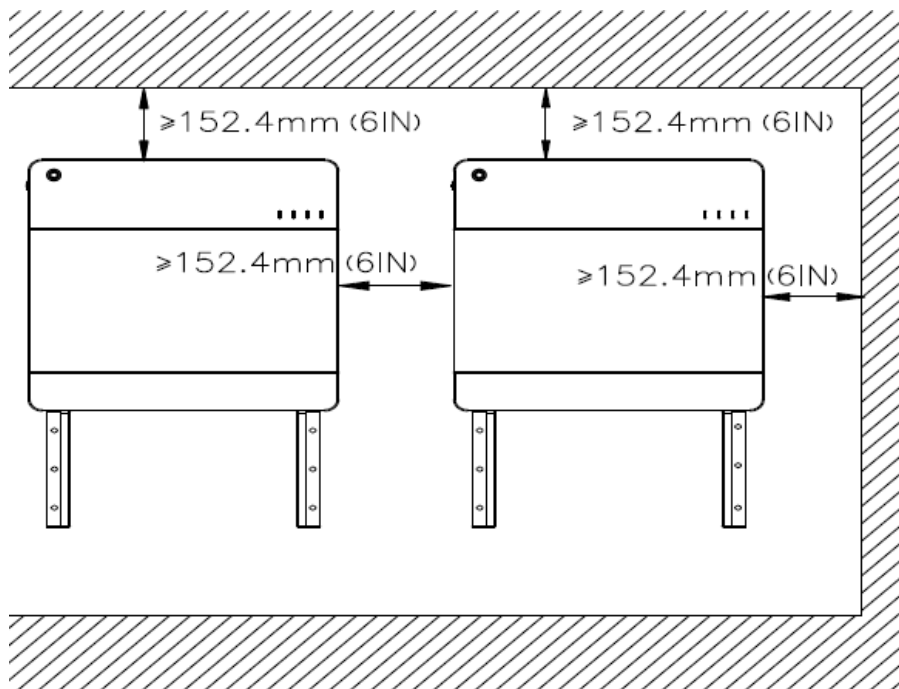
Requisitos dimensionais para instalação do suporte de parede
